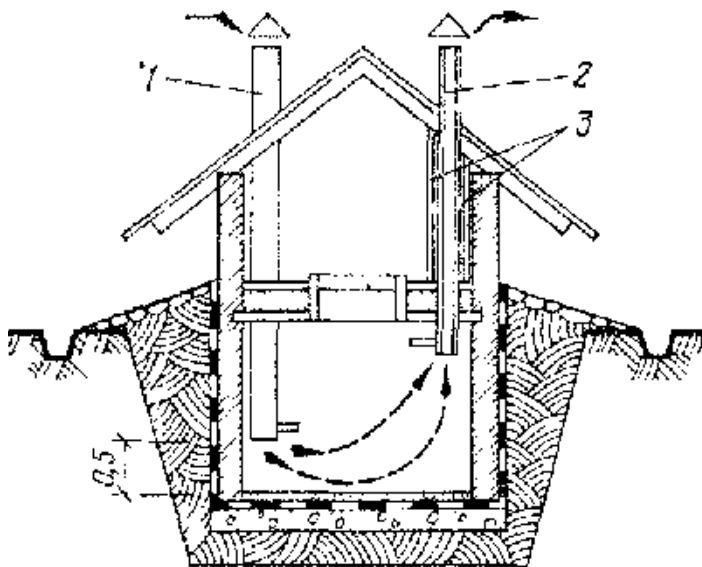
Устройство приточно-вытяжной вентиляции: 1- приточная труба; 2- вытяжная труба; 3- утепление (двойное)
